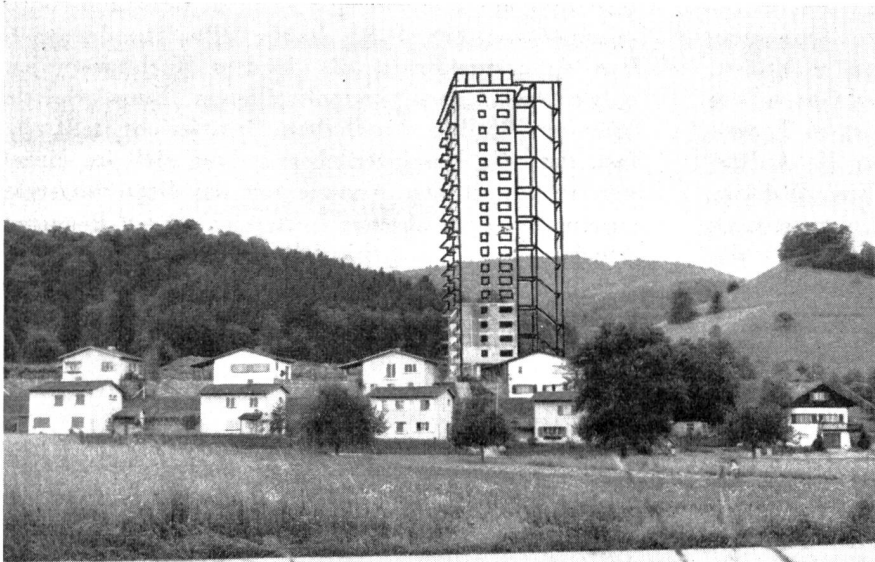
Photomontage des Hochhauses. Blick von Norden nach Süden. Im Vordergrund die kleinen Einfamilienhäuser; dahinter der fünfstöckige Hochhaustorso. Rechts am Hochhaus angehängt der zusätzliche Liftturm mit der vom Versicherungsamt verlangten Treppe. Diese Treppe ist frei und offen um den Turm geführt und mit einem normalen Stabgeländer geschützt. Durch den Ausbau dieses Treppenhauses vergrößert sich die Zone der zweistündigen Beschattung ganz wesentlich.
